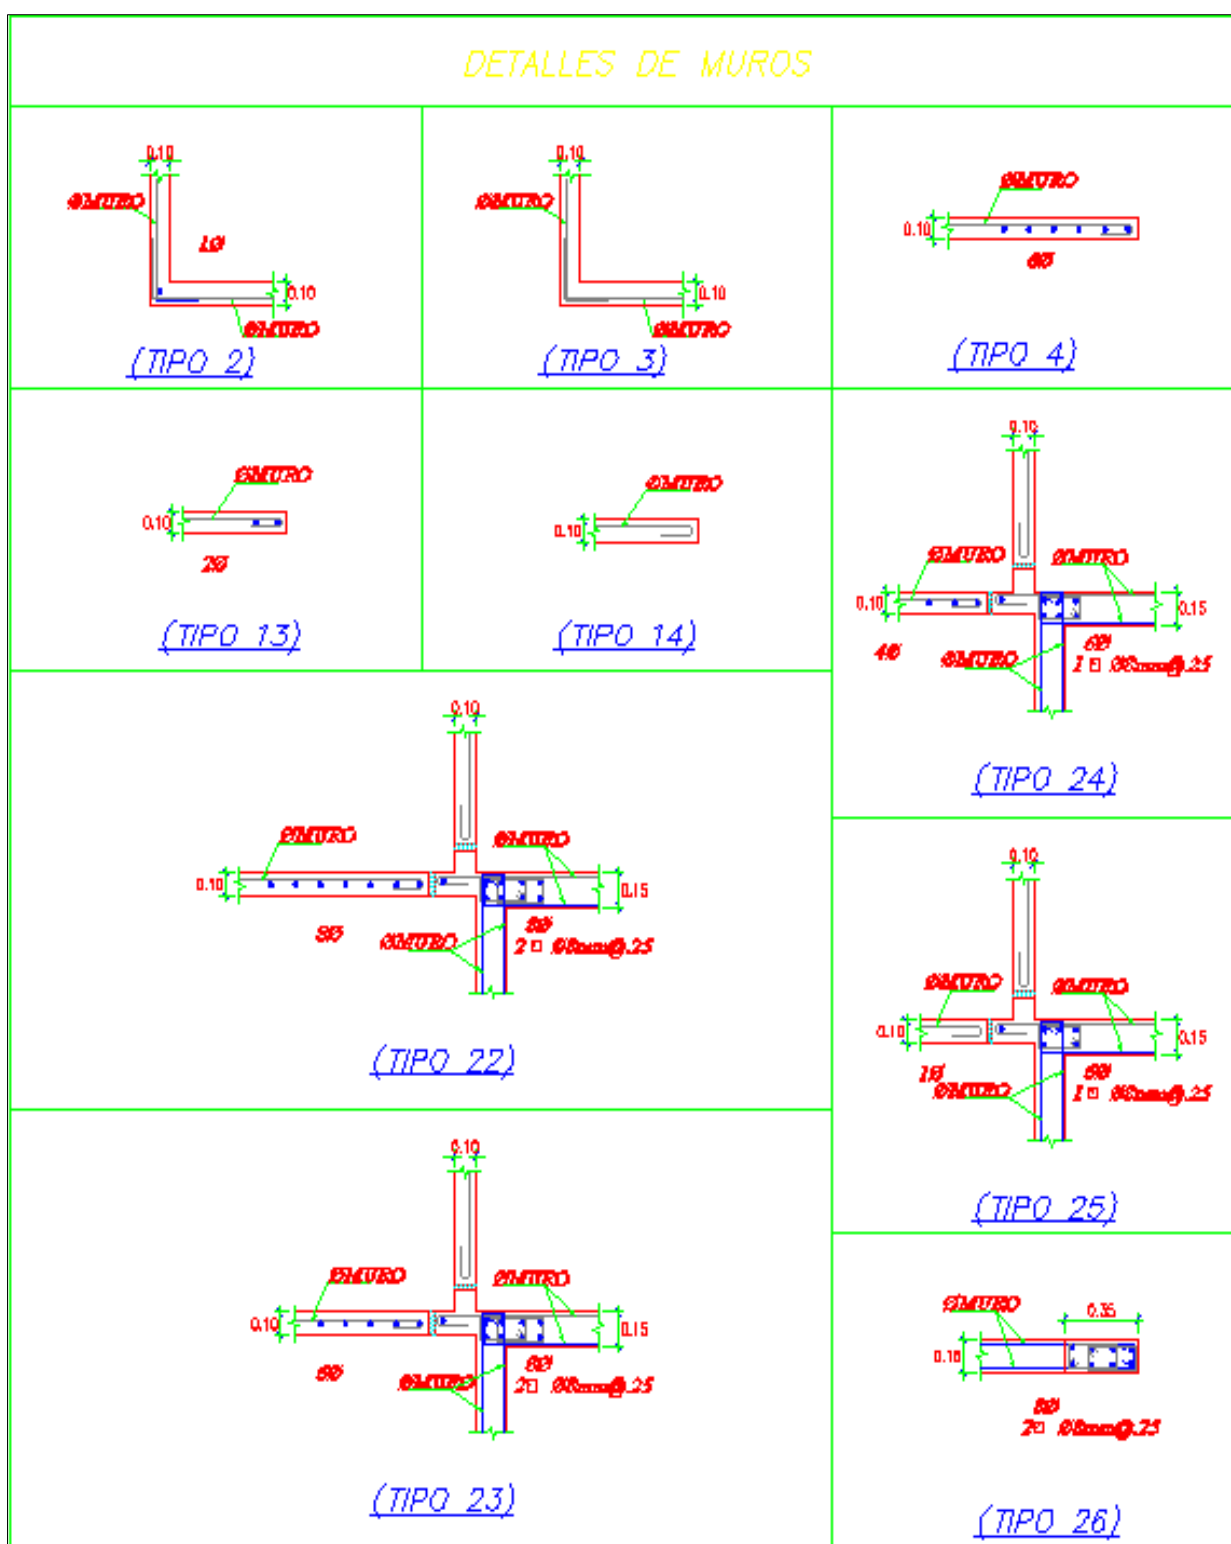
14. Tipos de detalles del muro propuesto (entre ejes 4-5 y E-G)
